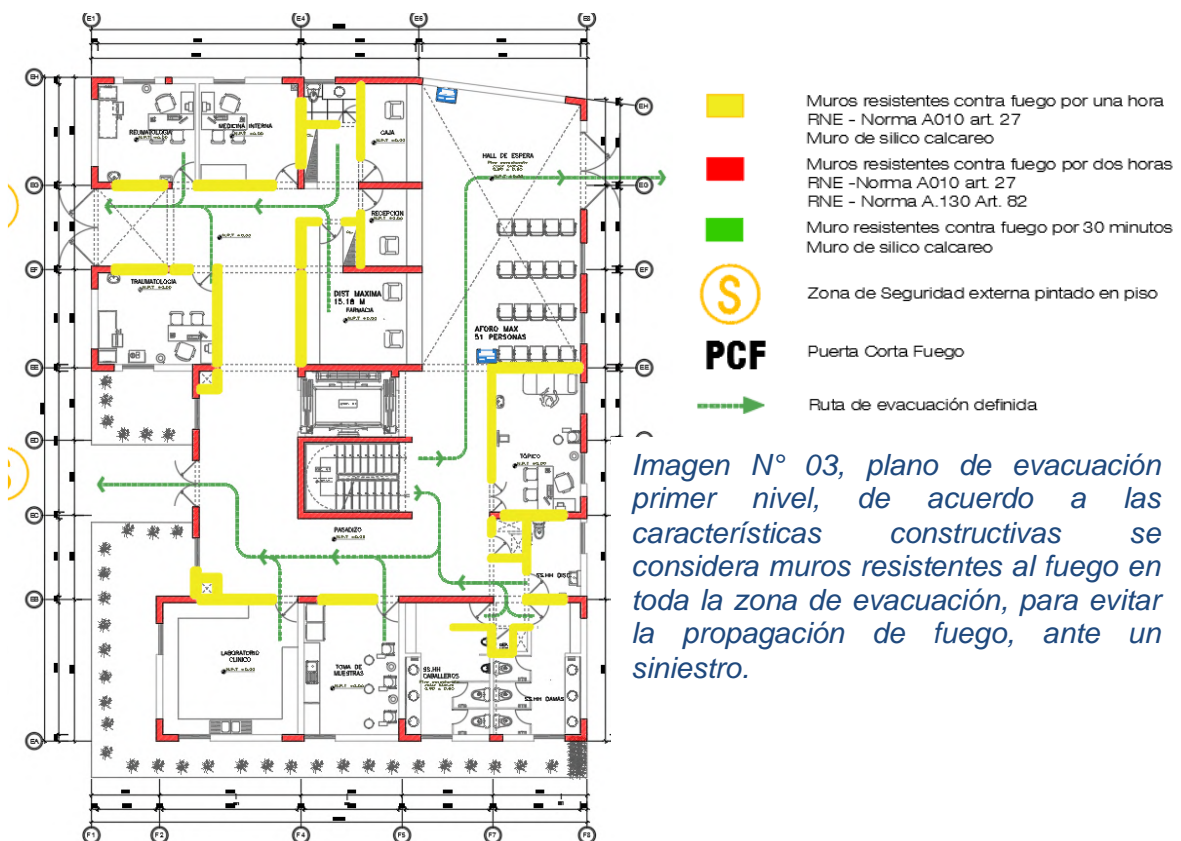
, plano de evacuación primer nivel, de acuerdo a las características constructivas se considera muros resistentes al fuego en toda la zona de evacuación, para evitar la propagación de fuego, ante un siniestro.
